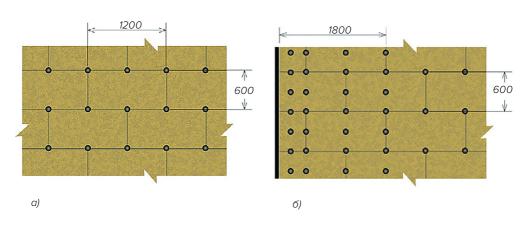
Схема установки гибких связей в системе слоистой кладки а) в основном поле стены, б) в углу здания.
